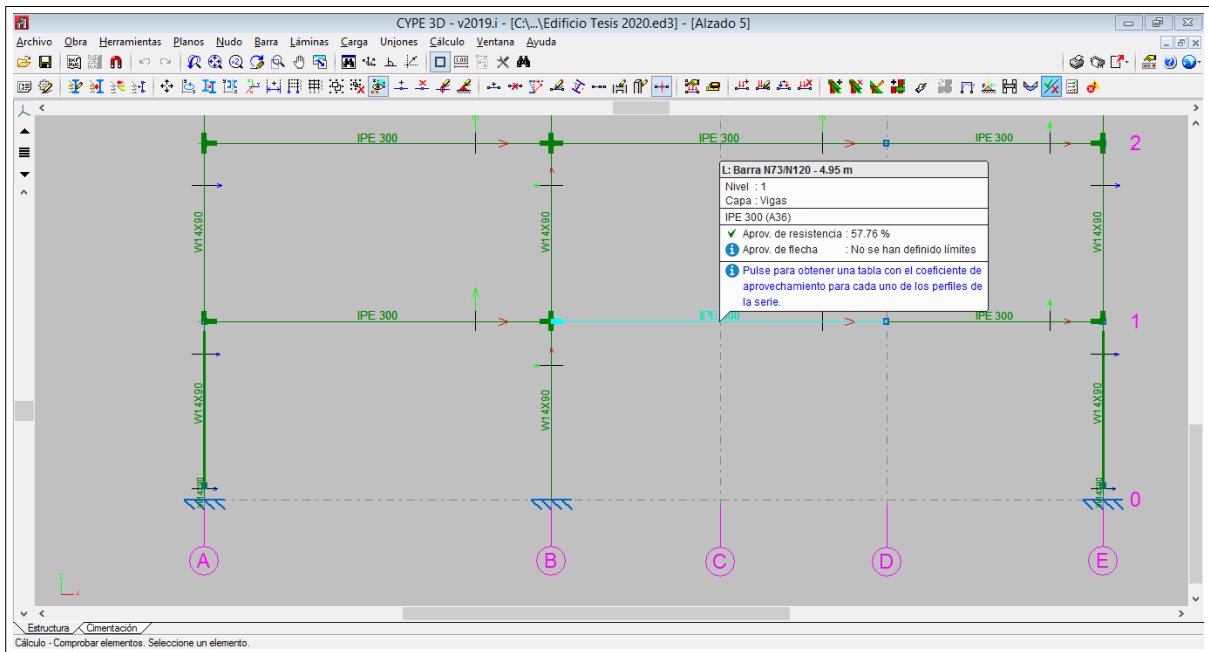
Se aprecia que el perfil IPE 300 (A36) predimensionado para la viga B-E cumple satisfactoriamente.
